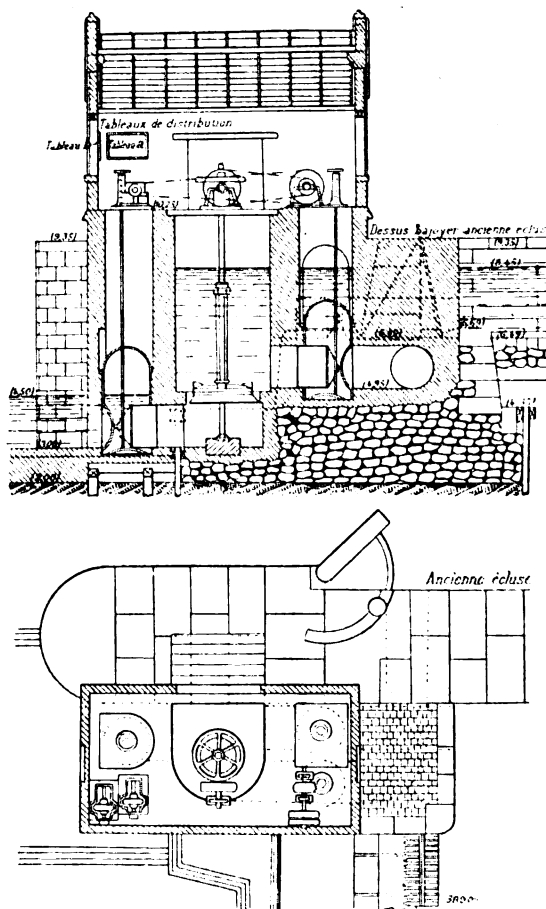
et 4. — Coupe longitudinale et plan au niveau du sol de l'usine électrique.
